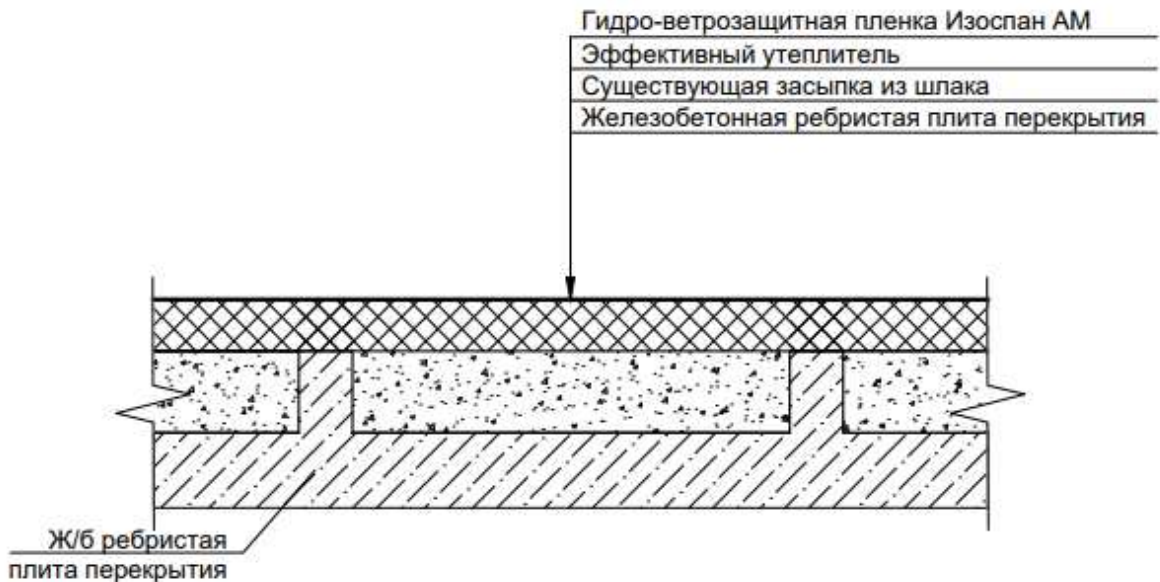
Утепление чердачного перекрытия железобетонного (ребристые плиты с засыпкой шлака до уровня ребер)
